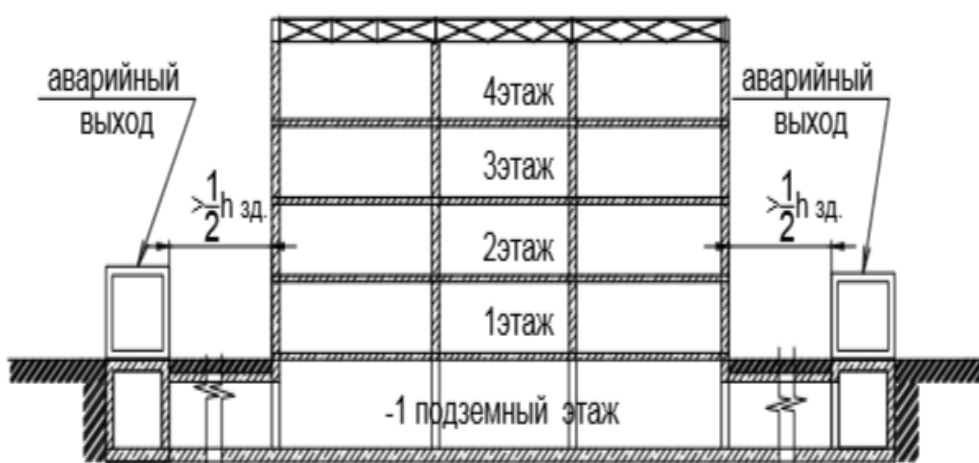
Вариант № 2 переустройства здания пожарной части (создание одного подземного этажа с двумя аварийными выходами)
